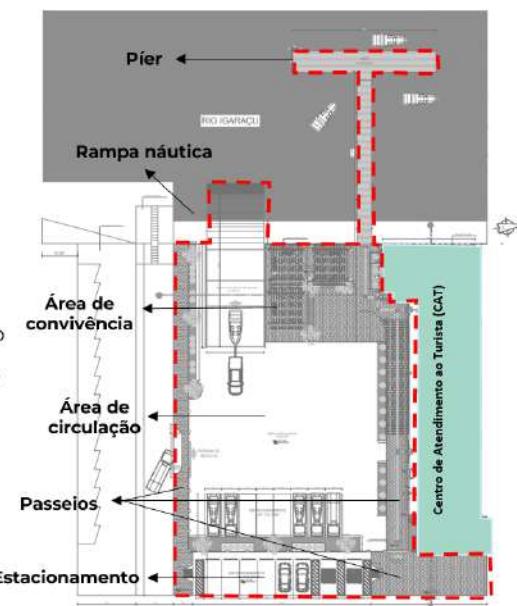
Layout preliminar do píer e rampa náutica a serem implantados em Parnaíba
